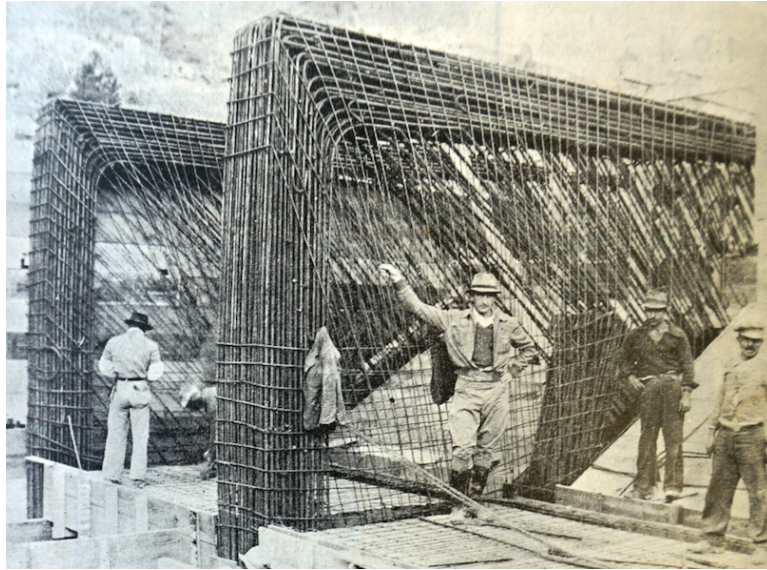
Construção dos quadros rígidos da Pista de Gelo. Detalhe das ferragens nos nós. FONTE: CONCRETO, 1943.
